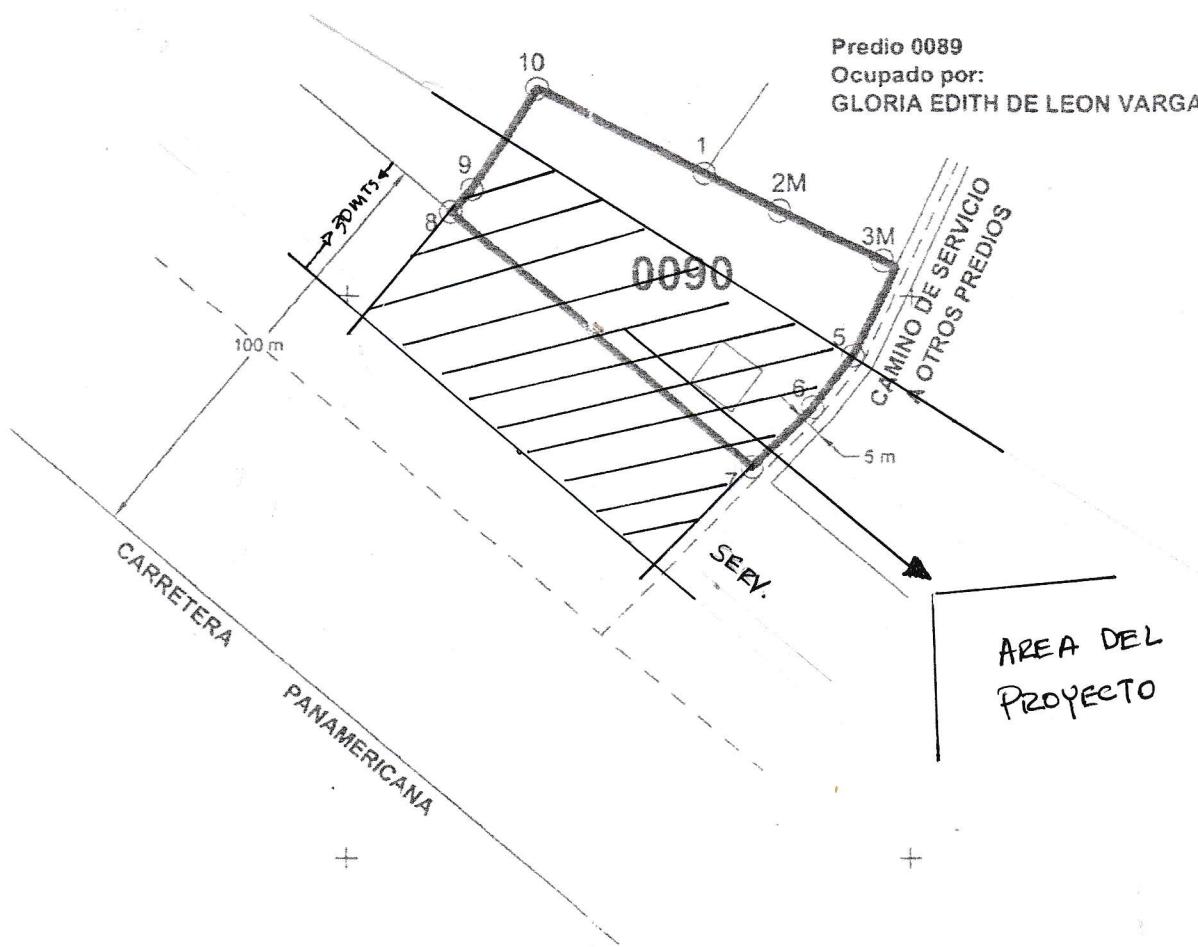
Vista Panamericana del área del proyecto. Fuente: Julio Cruz /2019.
